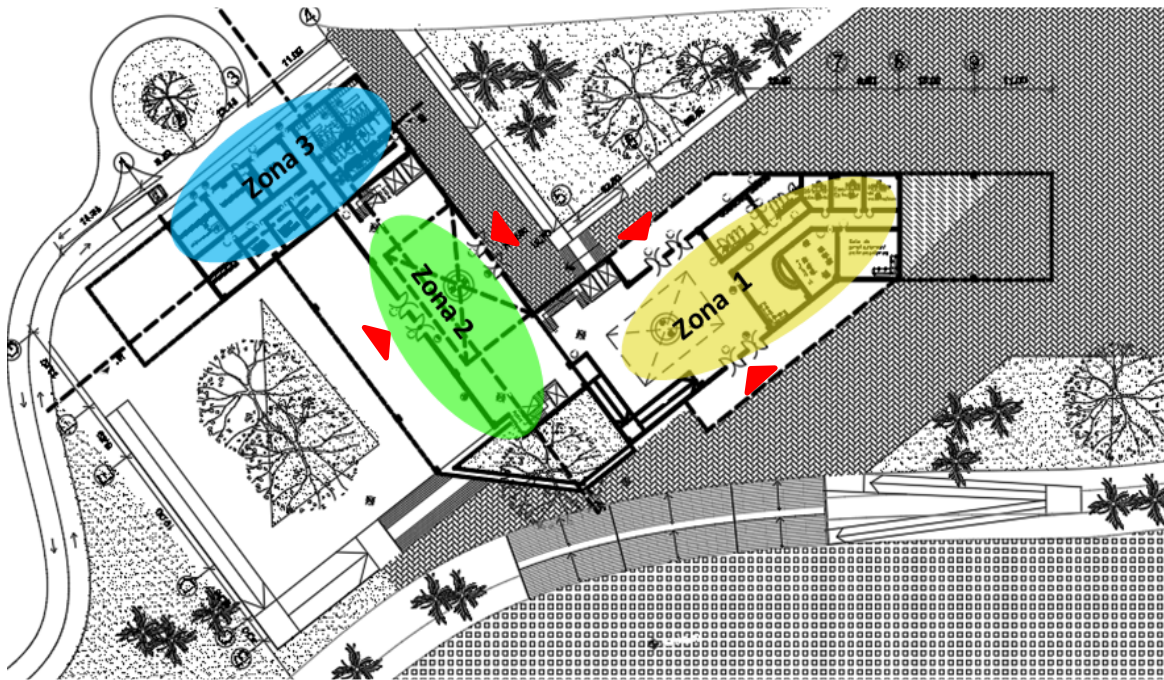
Planta baja edificación principal N+ 648.00 (2017).
